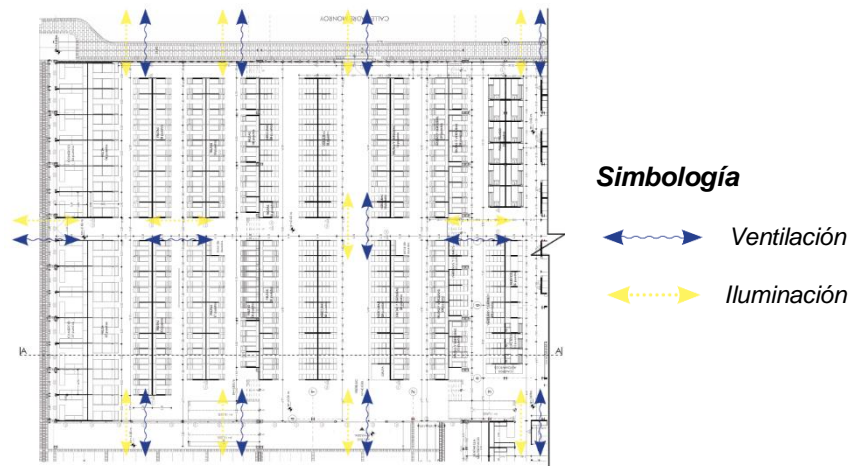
Ventilación e iluminación en planta del mercado 12 de abril
